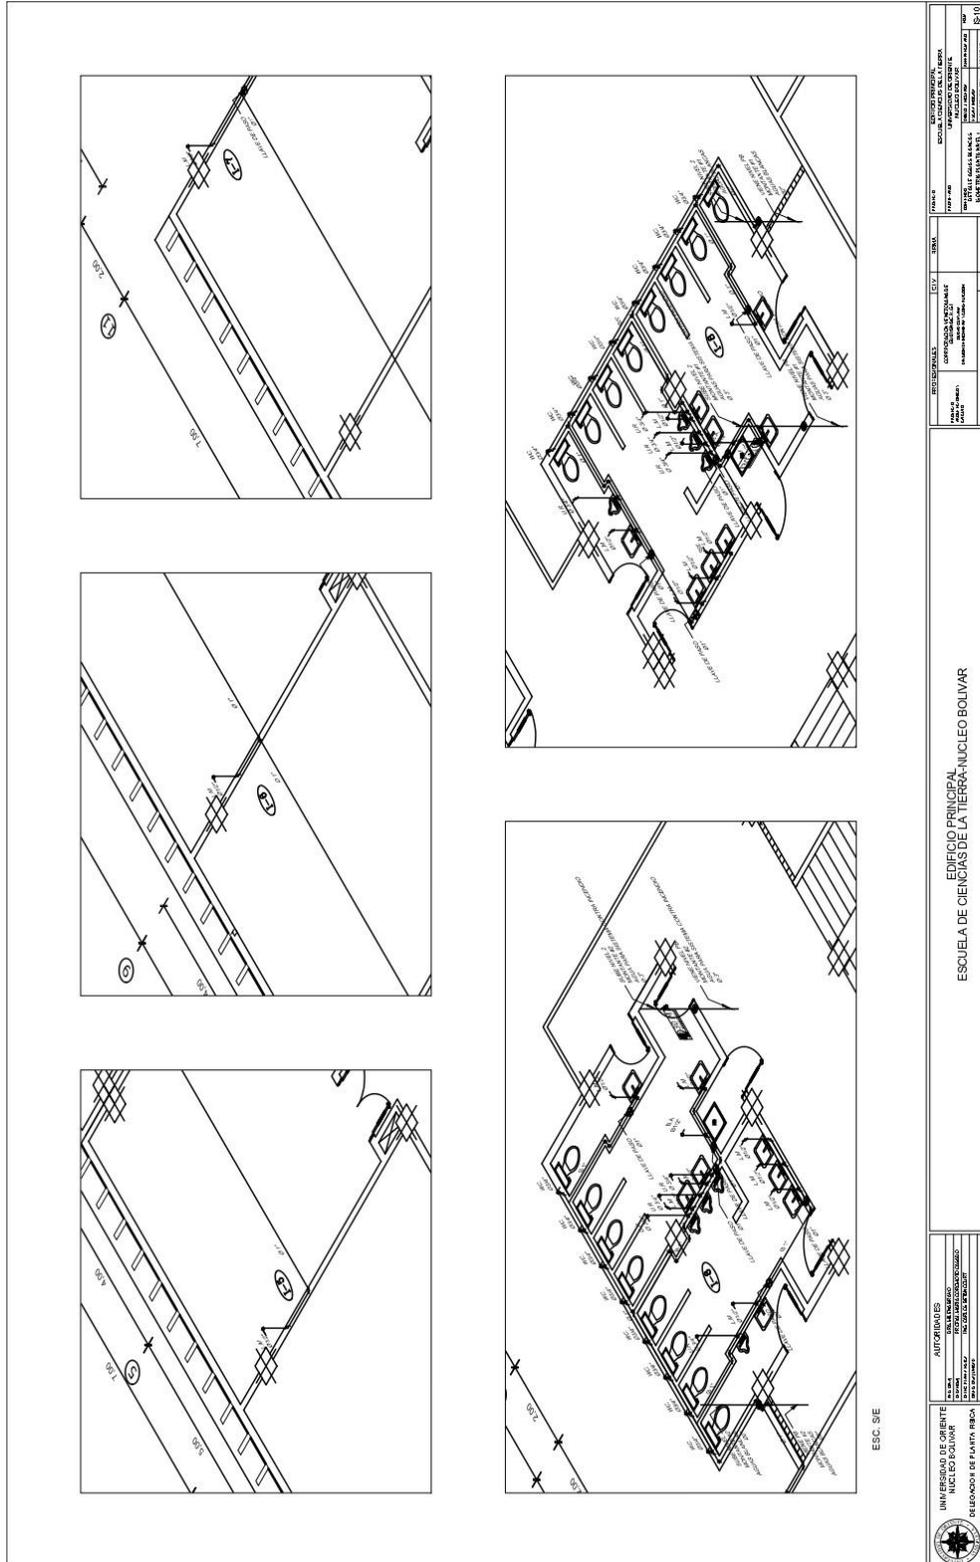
Detalle Aguas Blancas Isometría Planta Nivel 1
